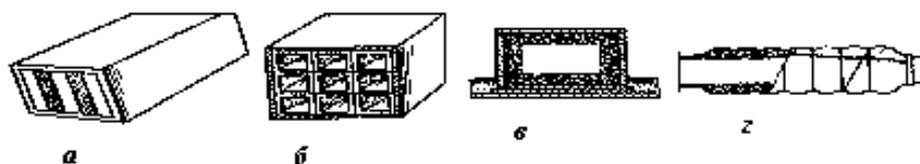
Глушители шума штучные: а – пластинчатый; б – «сотовый»; в – трубчатый прямоугольный; г – трубчатый круглый
